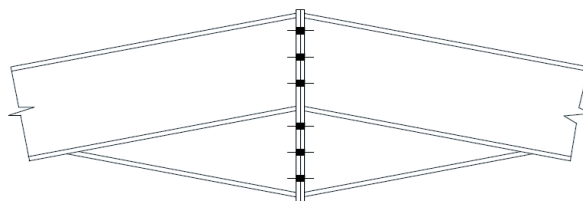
Ligação tipo cumeeira (SECHALO, *Steel buildings in europe - single-storey steel buildings - Part2: Concept design, 2012*)
